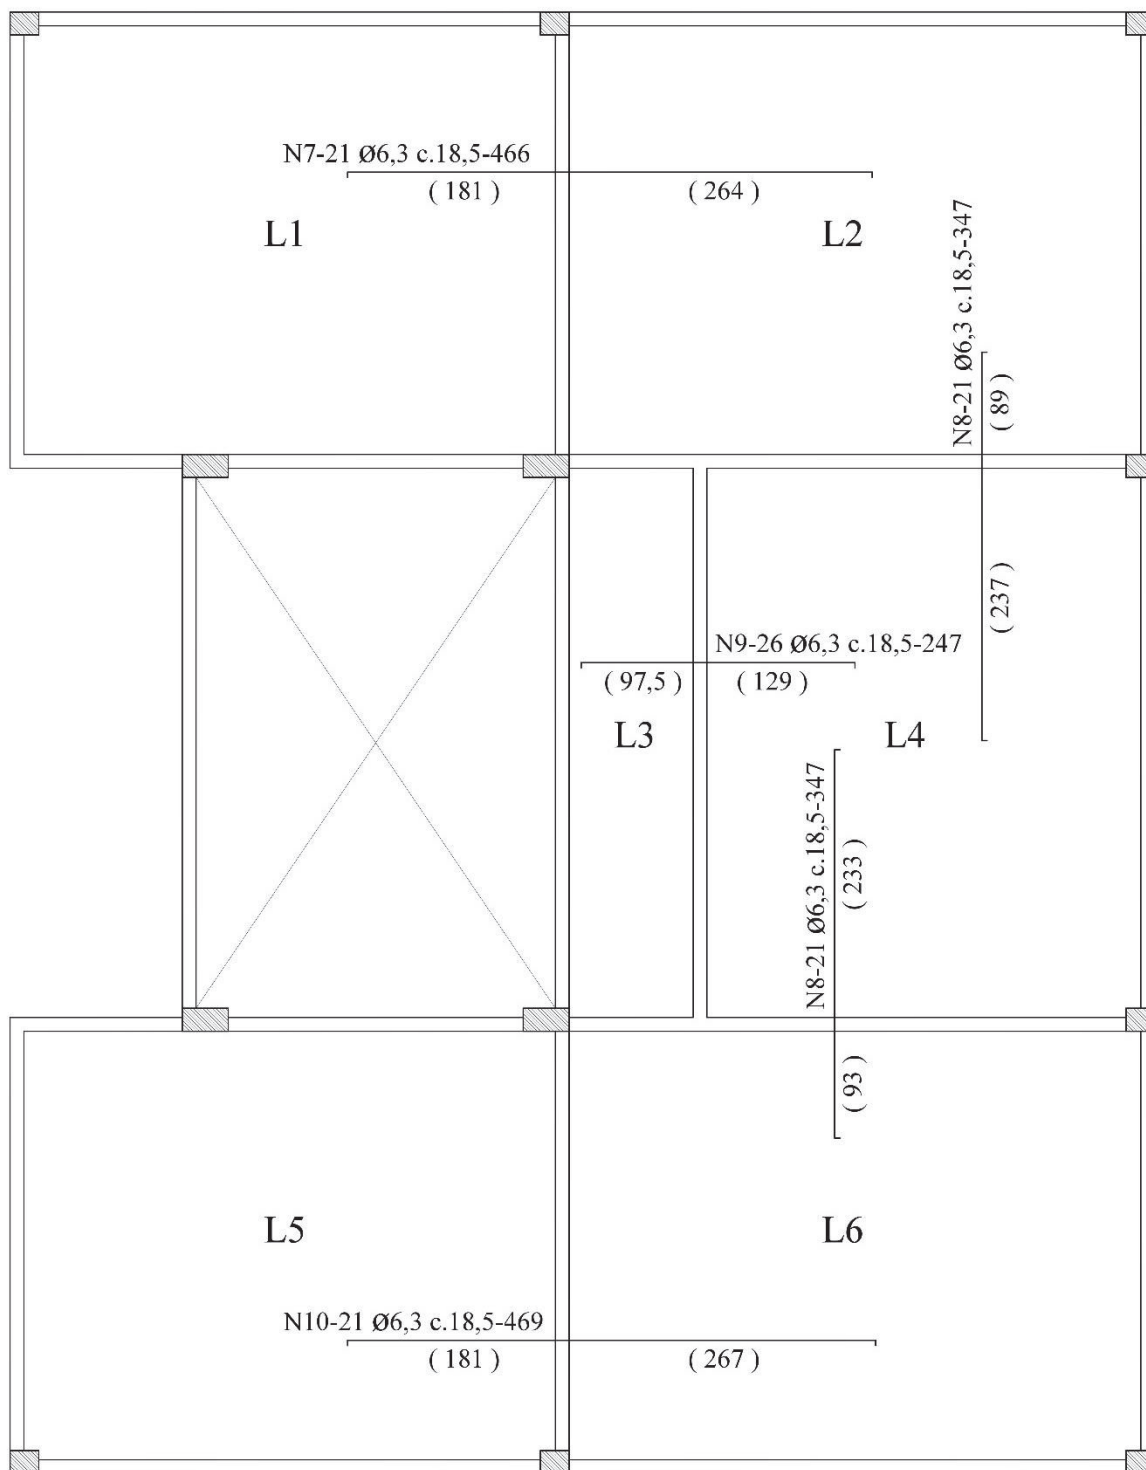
Detalhamento das armaduras positivas (análise plástica)
